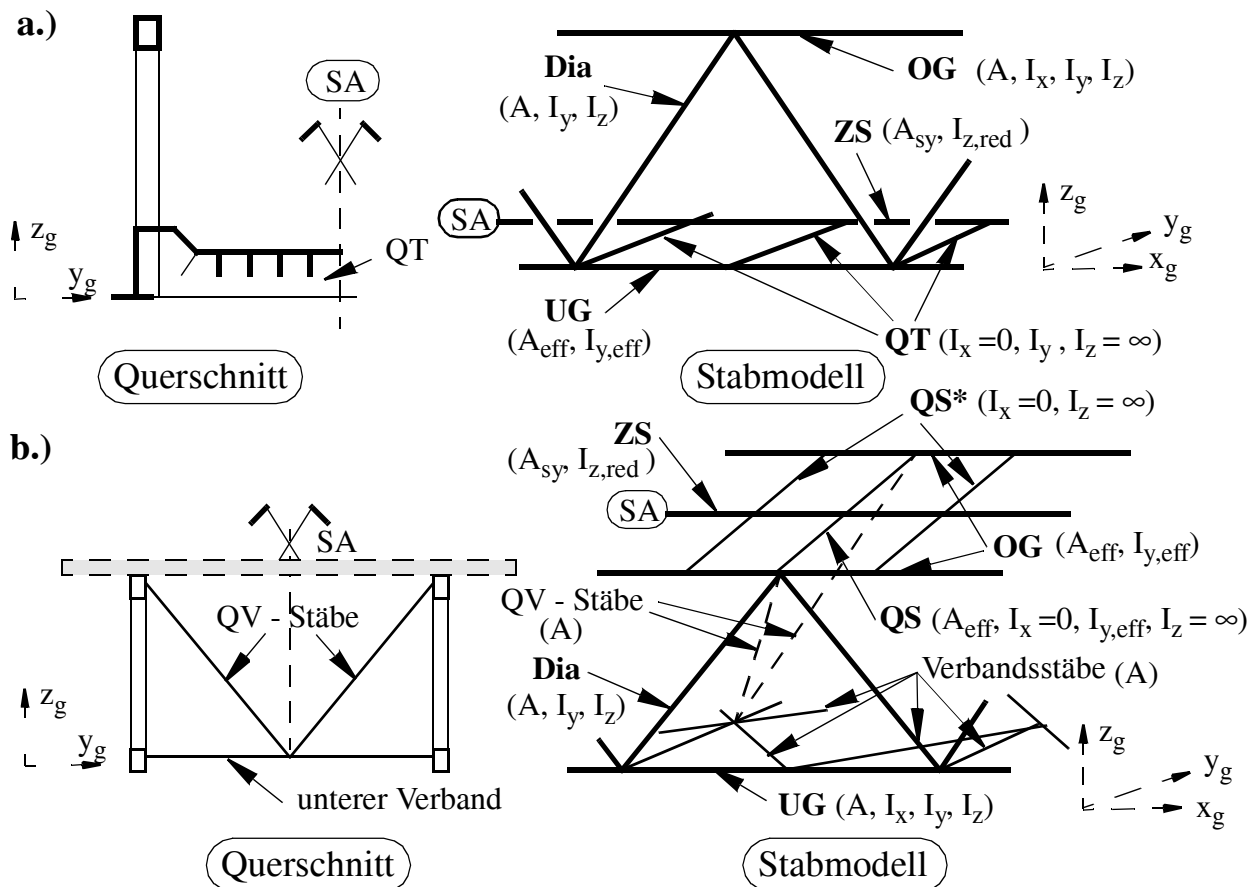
Adaptiertes räumliches Stabmodell im Fall von HT in Fachwerkbauweise; a.) Trogbrücke, b.) Deckbrücke.
